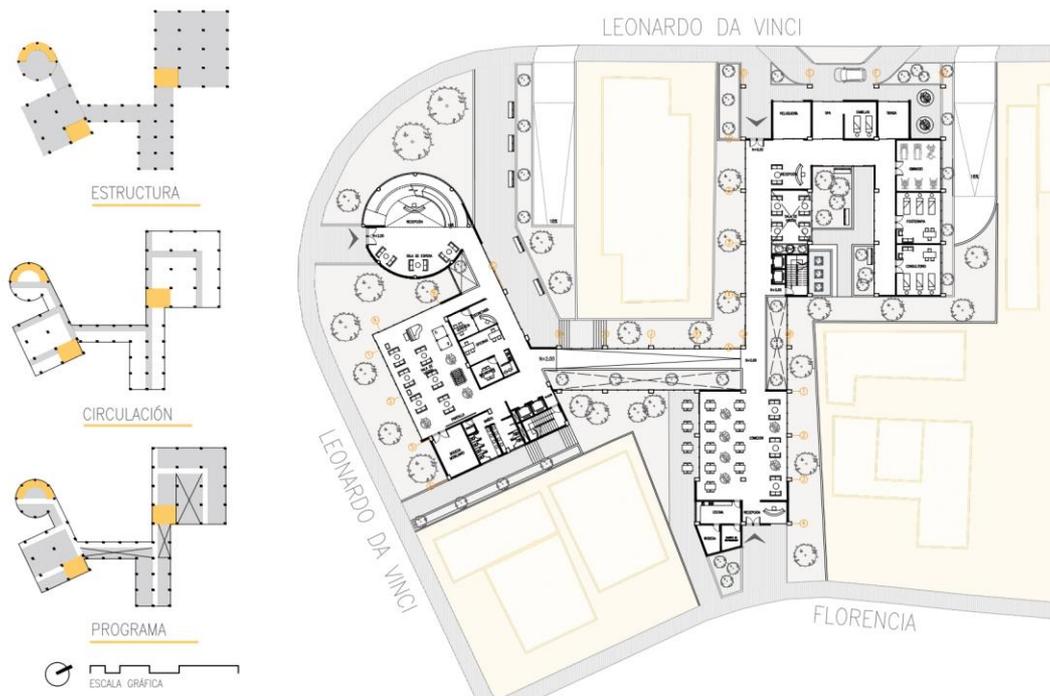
Planimetría: Planta baja (N+0.00). Elaboración propia.
